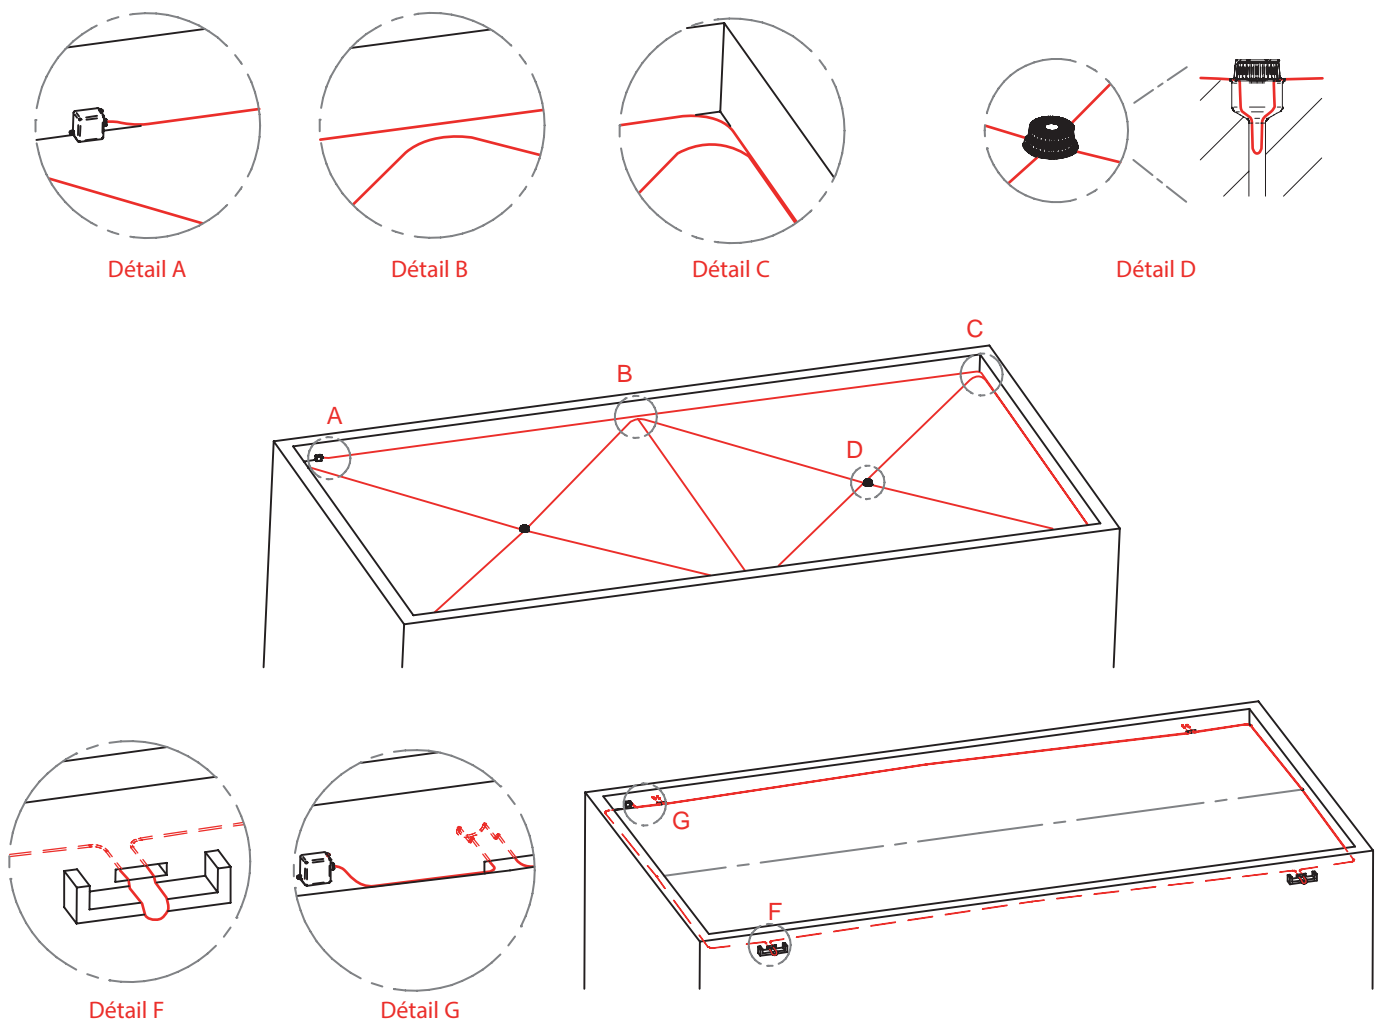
Installation avec drain et chemin d'écoulement sur toit plat
